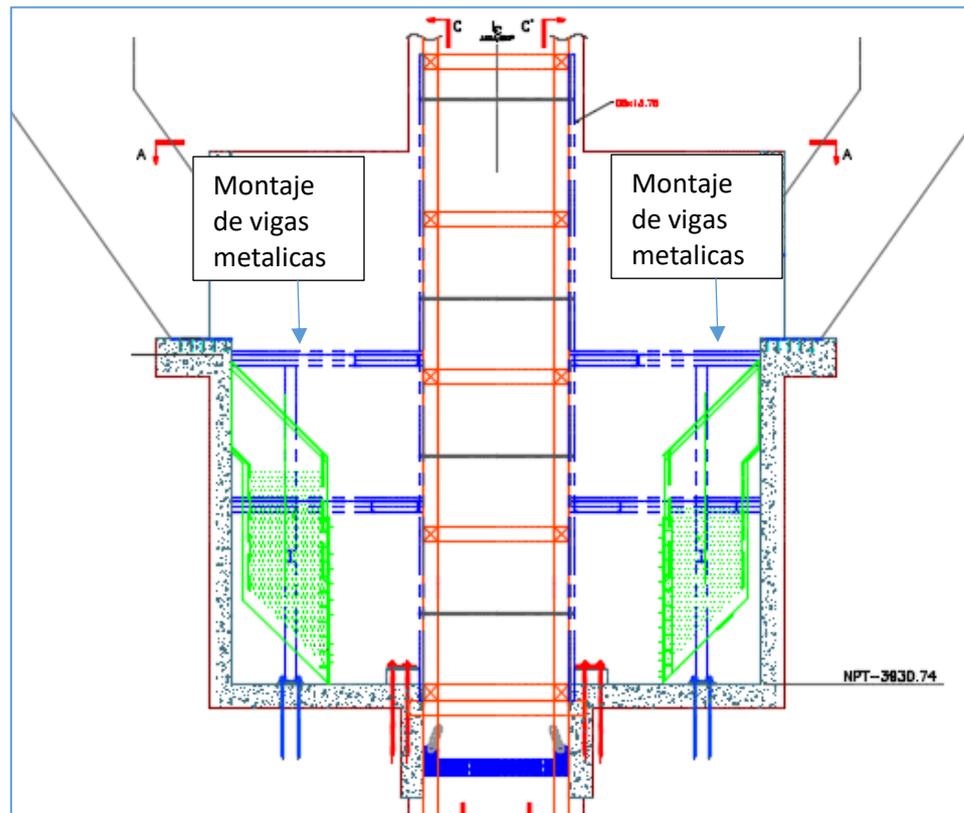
vista en perfil montaje de columnas y vigas metalicas
